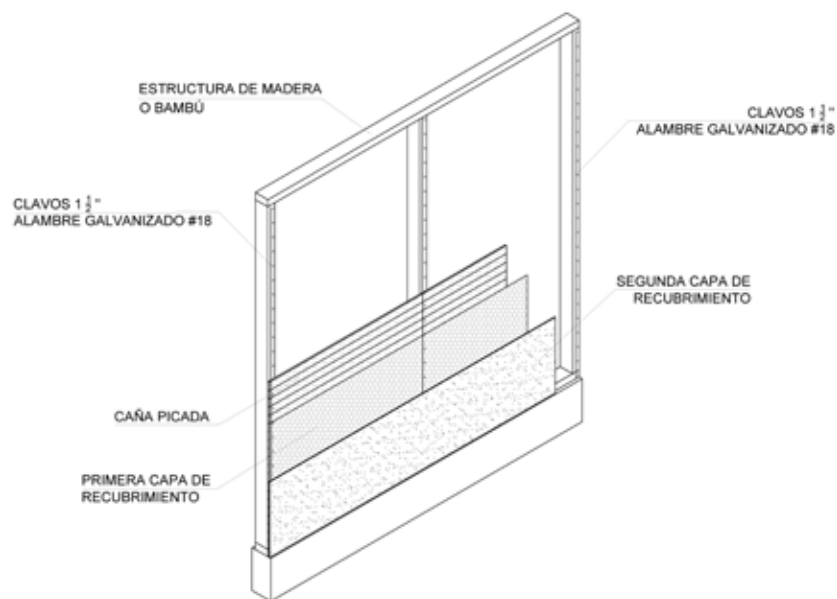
Componentes del muro de bahareque encementado (INBAR, 2011)
